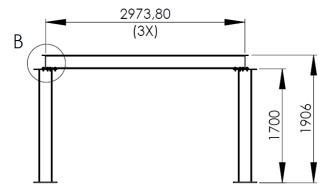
Perfil da viga da nova estrutura projetada (O autor, 2019)
